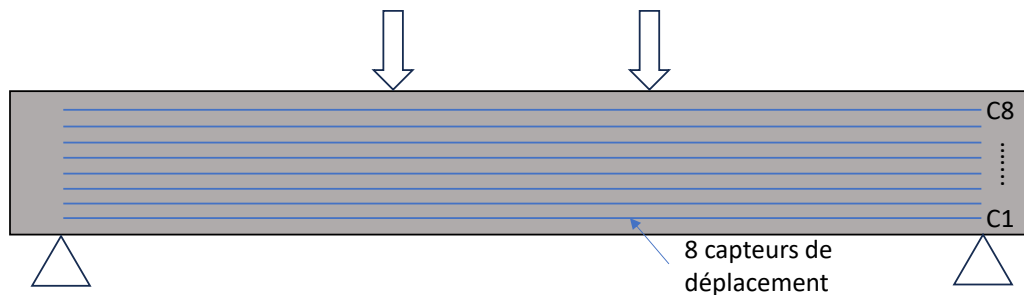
Position des capteurs pour déterminer la répartition des fissures sur la hauteur des poutres
